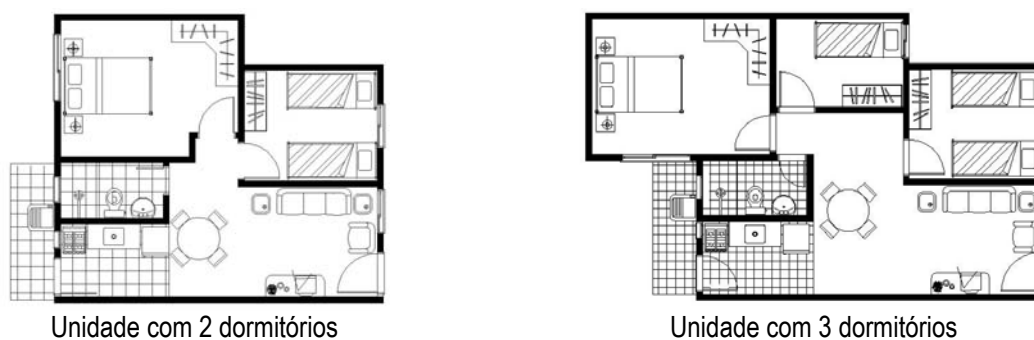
Planta baixa UH de dois e tres dormitórios – empreendimento SL
